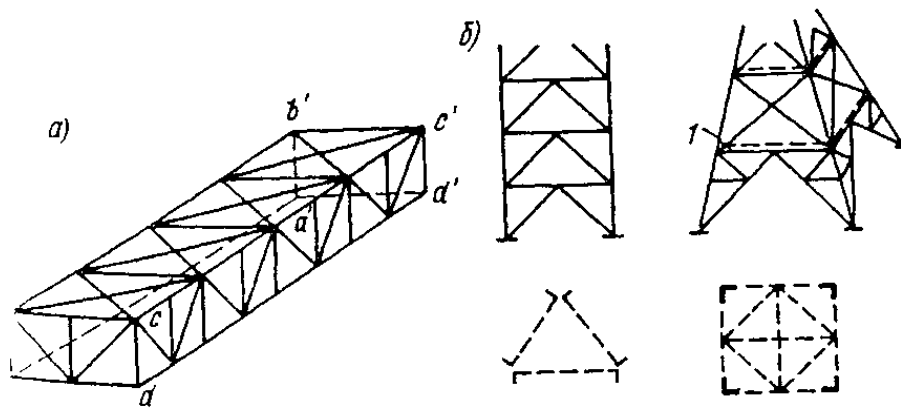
Зв'язка ферм у просторові системи; 1 – діафрагма
